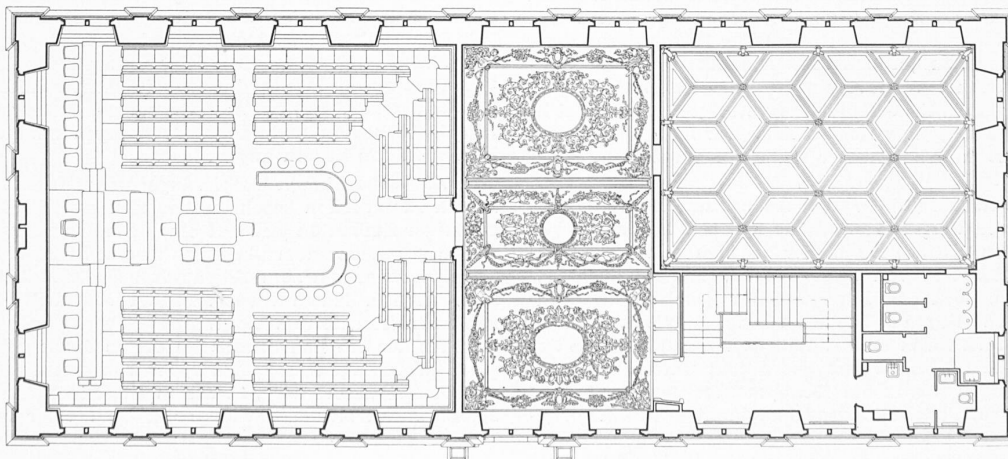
Grundriss erster Stock, 1:250. Kantonsratsaal, Vorhalle und Regierungsratsaal
